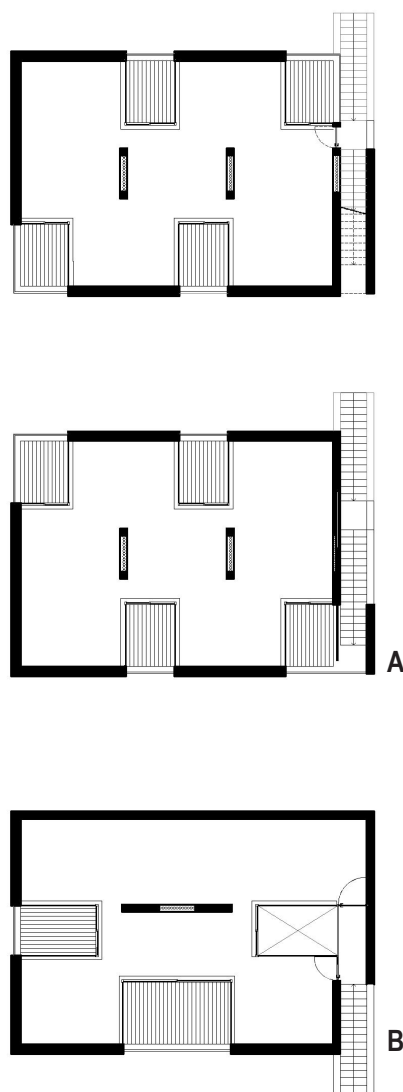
Planta da base estrutural Habitação tipo A e tipo B
